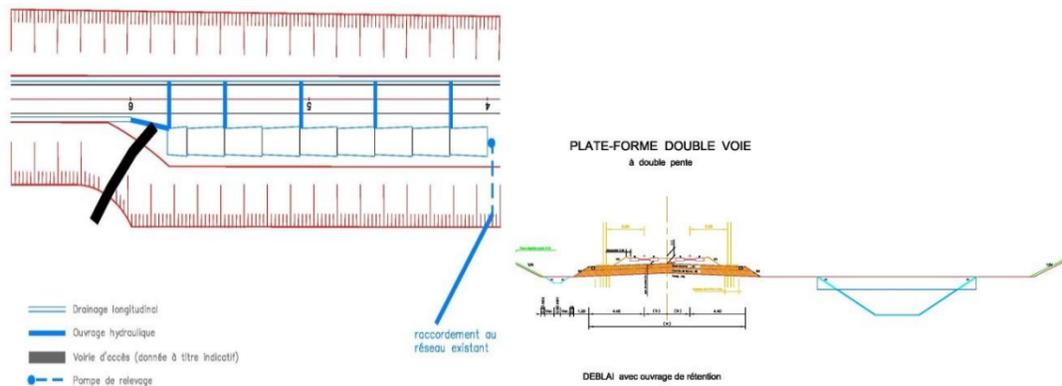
Schéma de principe du dispositif de rétention en amont hydraulique du tunnel
